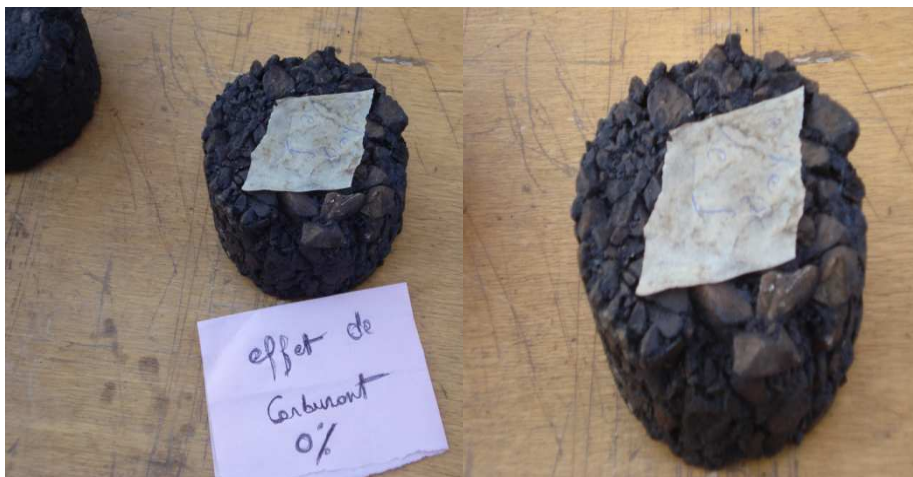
Eprouvettes (0%) après immersion dans le carburant
